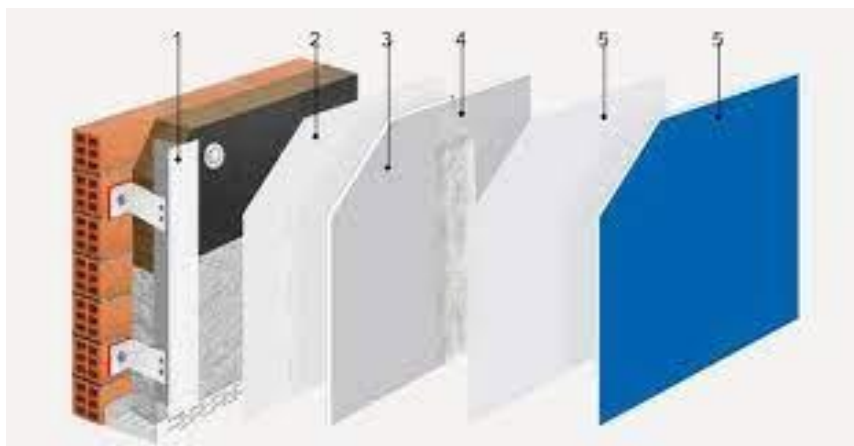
Detalhe construtivo dos elementos constituintes de fachada ventilada com revestimento em placas de gesso laminado [73].
